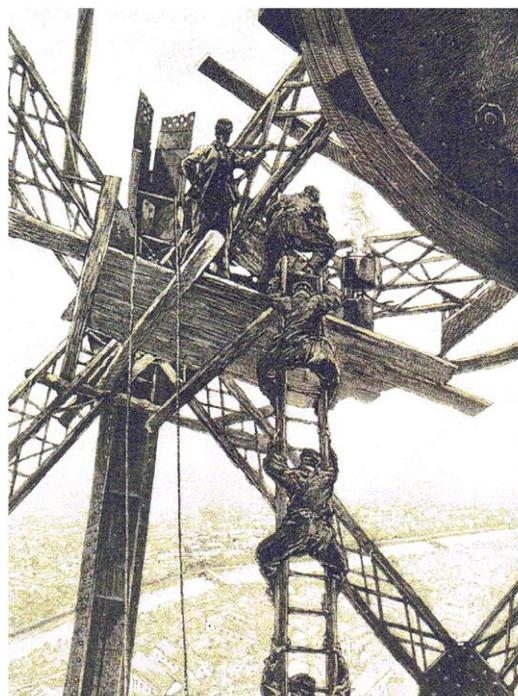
La journée de travail des ouvriers de la Tour débute et se clôt par l'escalade de vertigineuses échelles de chantier (*L'illustration* 29-12-1888)
